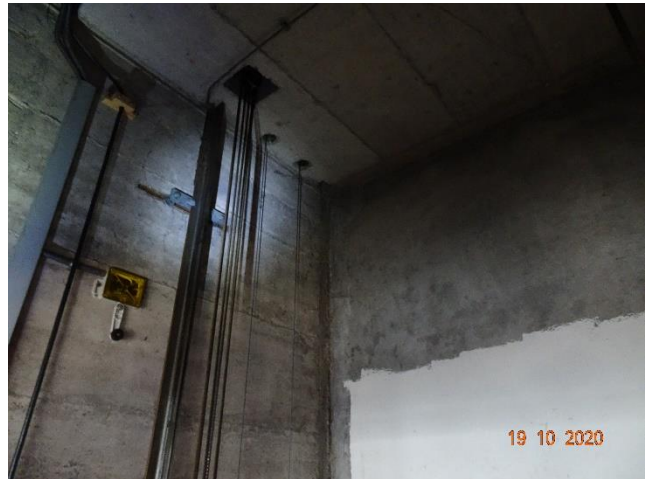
Aufzugsschacht, ohne Versteckstrukturen
